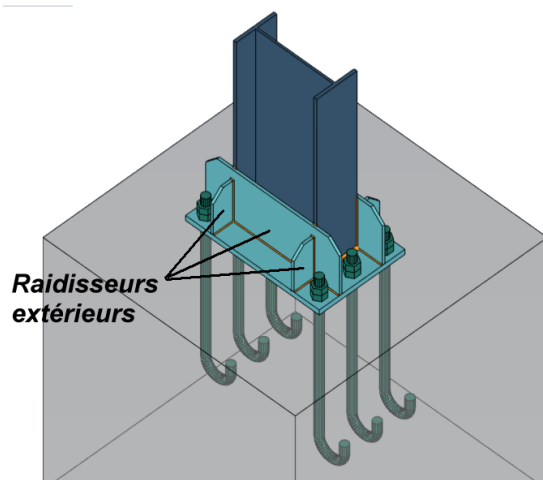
Pied de poteau encastré avec raidisseurs extérieurs
